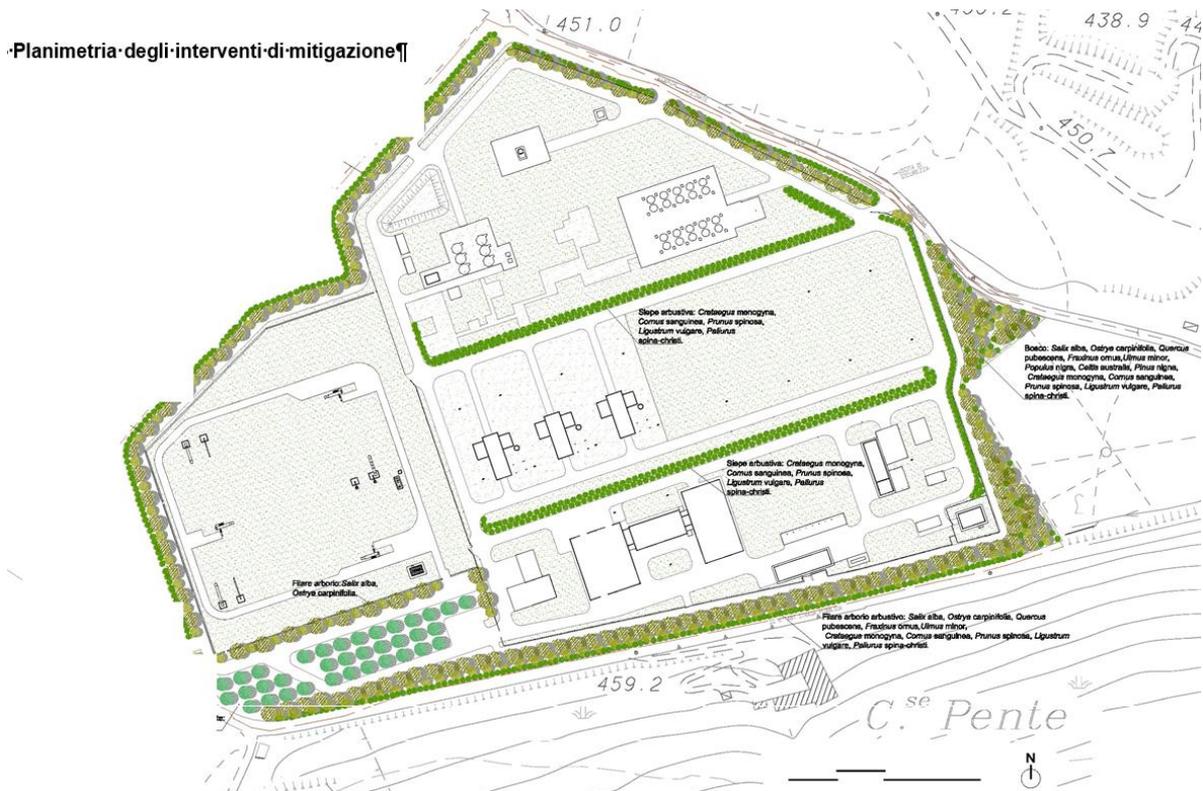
Stralcio layout del progetto di massima delle opere di mitigazione a verde della centrale (non in scala) ripreso dall'elaborato SPC. BG-E-94706 - Allegato 3 - Approfondimento della componente paesaggio
